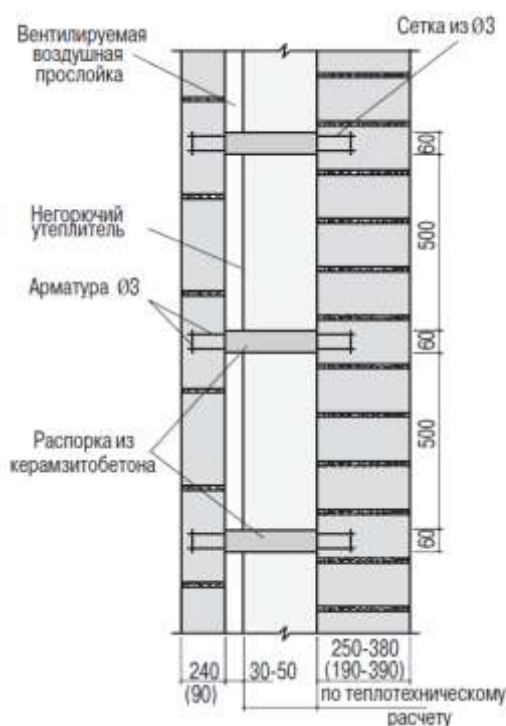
Схема установки керамзитовых распорок в уровне низа междуэтажного перекрытия. Сечение 13-13
